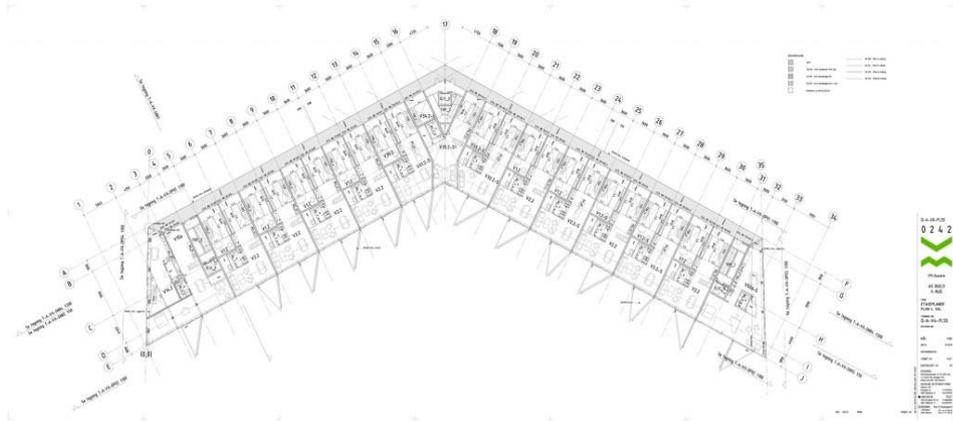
Planta arquitectónica del bloque "V" de VM Houses.
